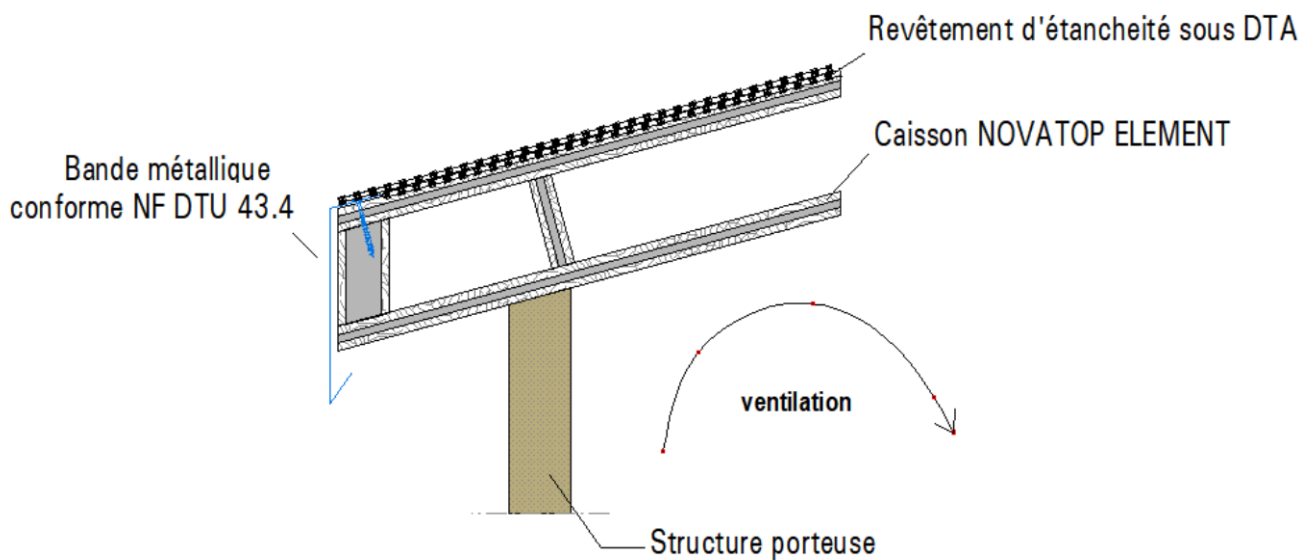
B1 – Rive de toiture froide ventilée (Auvent, préau, bâtiments ouverts non isolés, non chauffés) - revêtement d'étanchéité autoprotégé bicouche
